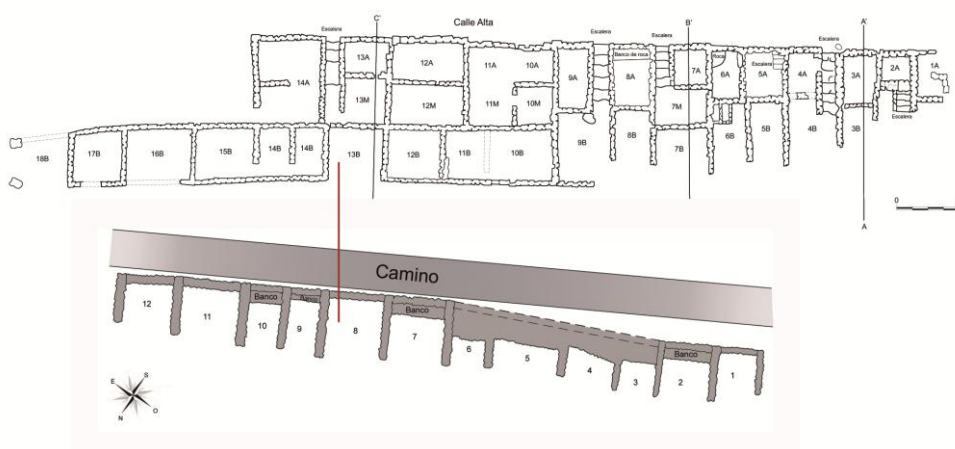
Equivalencia planimetría M. Tarradell y F. García Hernández
